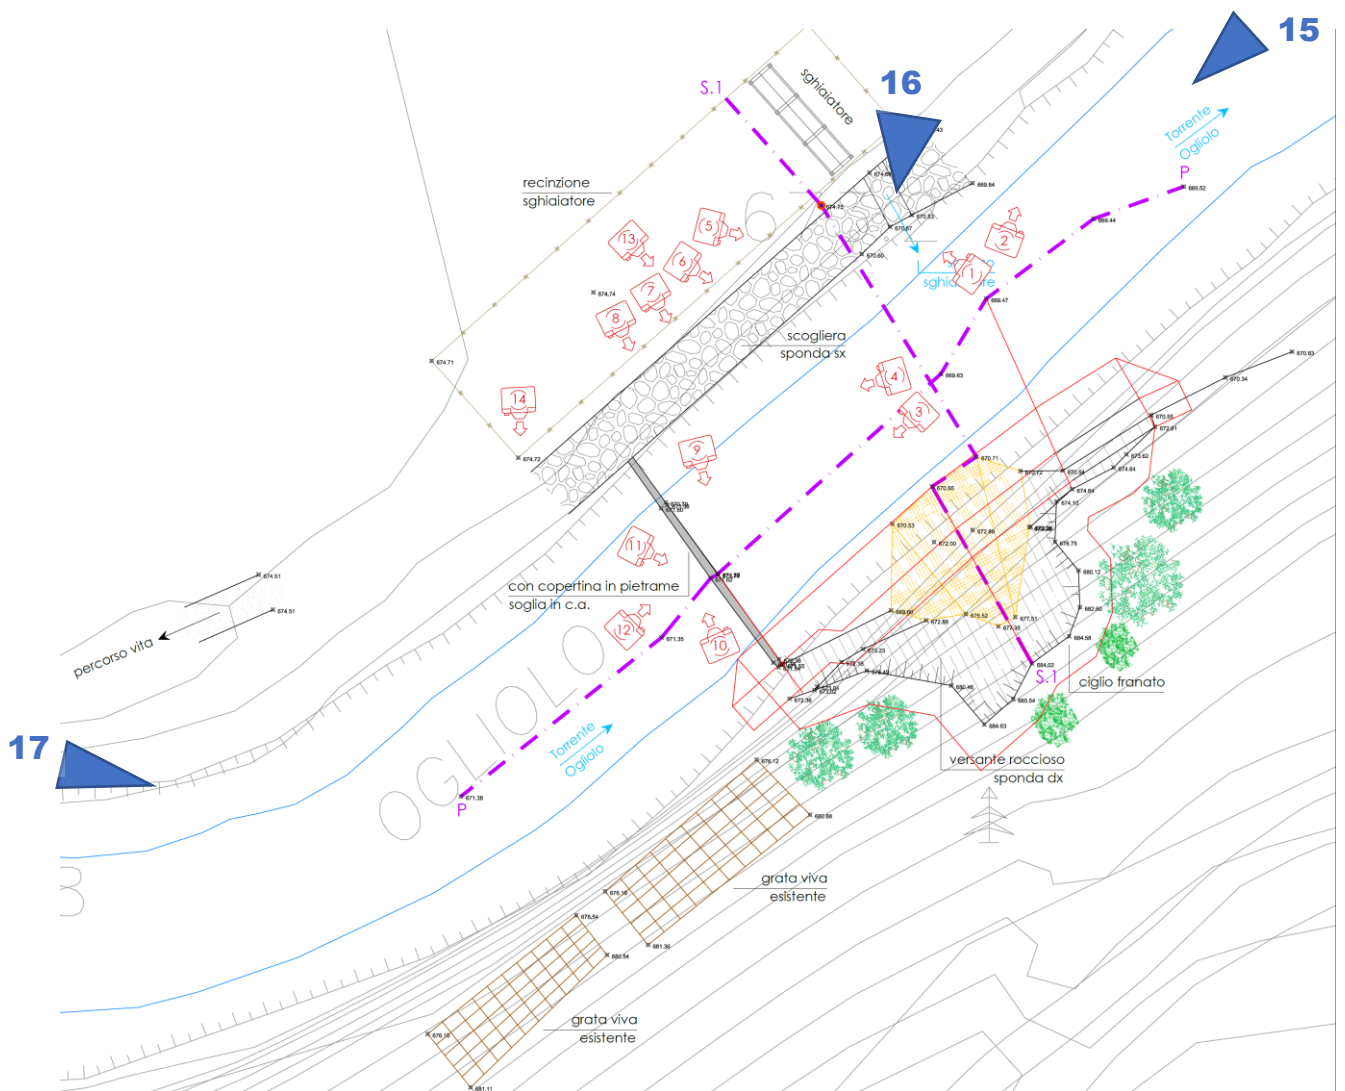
Stralcio planimetria di progetto intervento 5 con viste fotografiche
